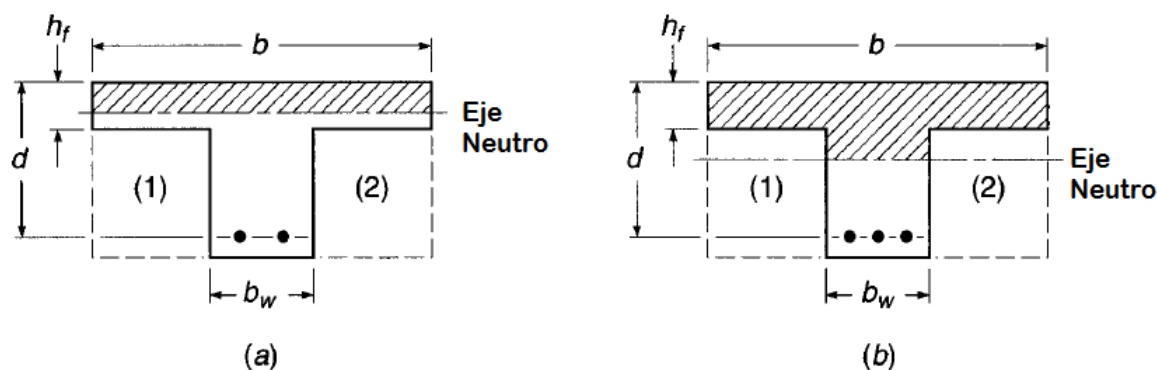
Ancho efectivo de ala para vigas T.
